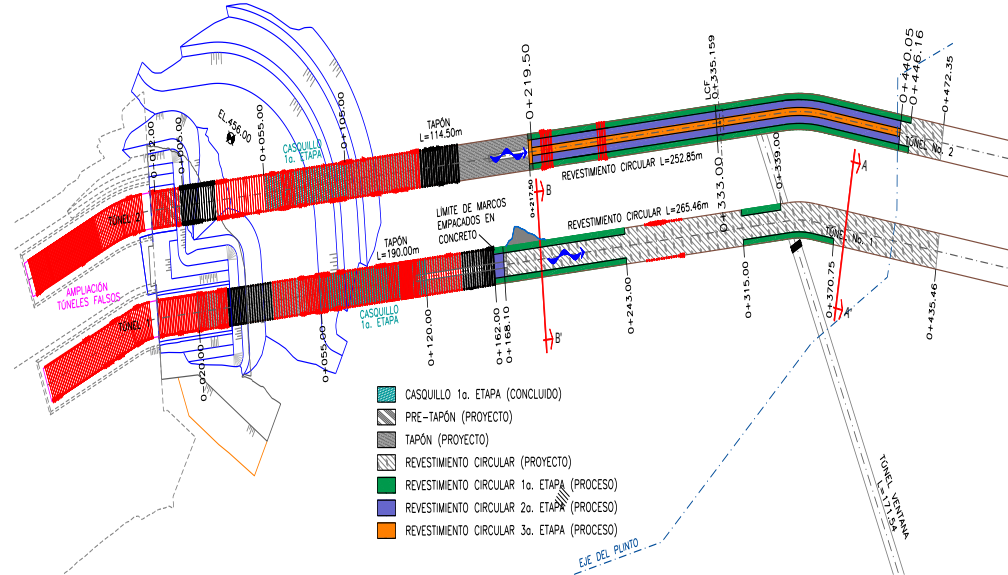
Obra de desvío en planta de los túneles donde se indican los casquillos y revestimiento de la obra de desvío del P. H. La Yesca.
